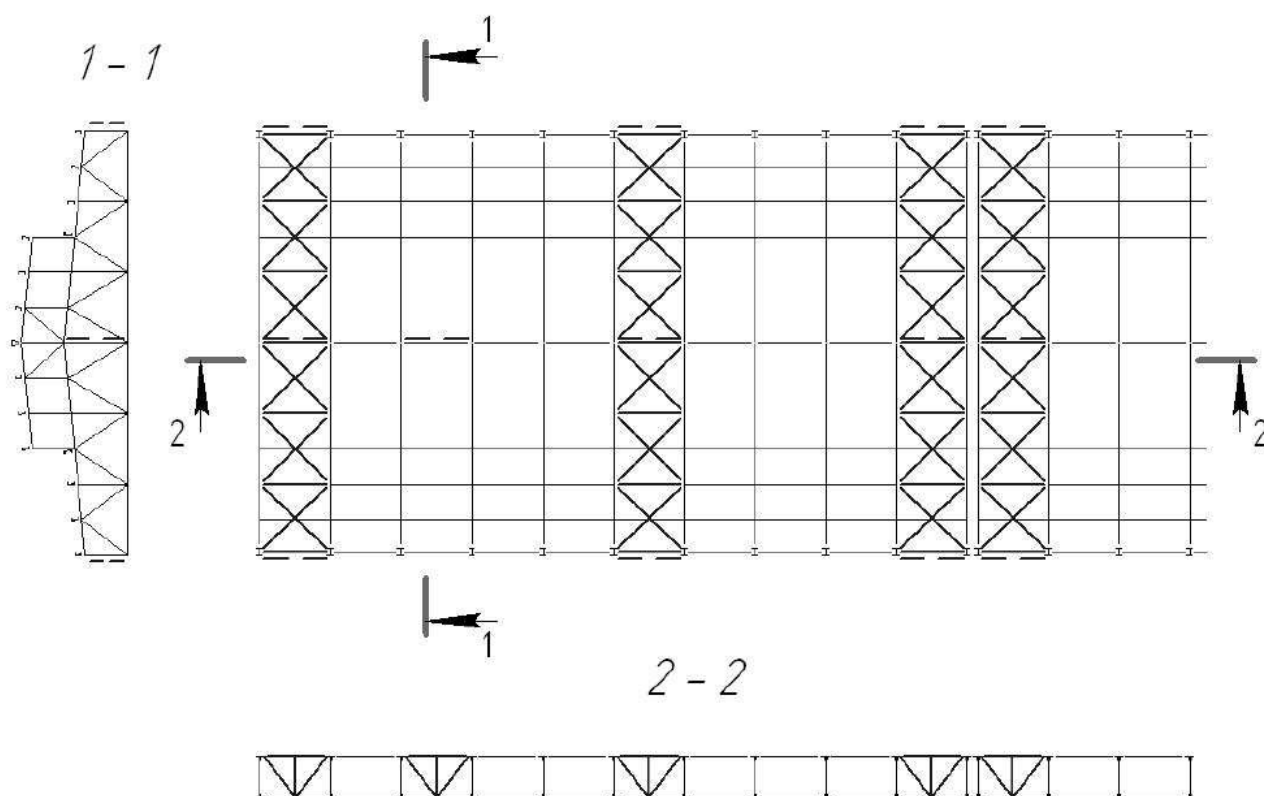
Поперечные связи между верхними поясами ферм. Вид 2-2 - вертикальные связи
